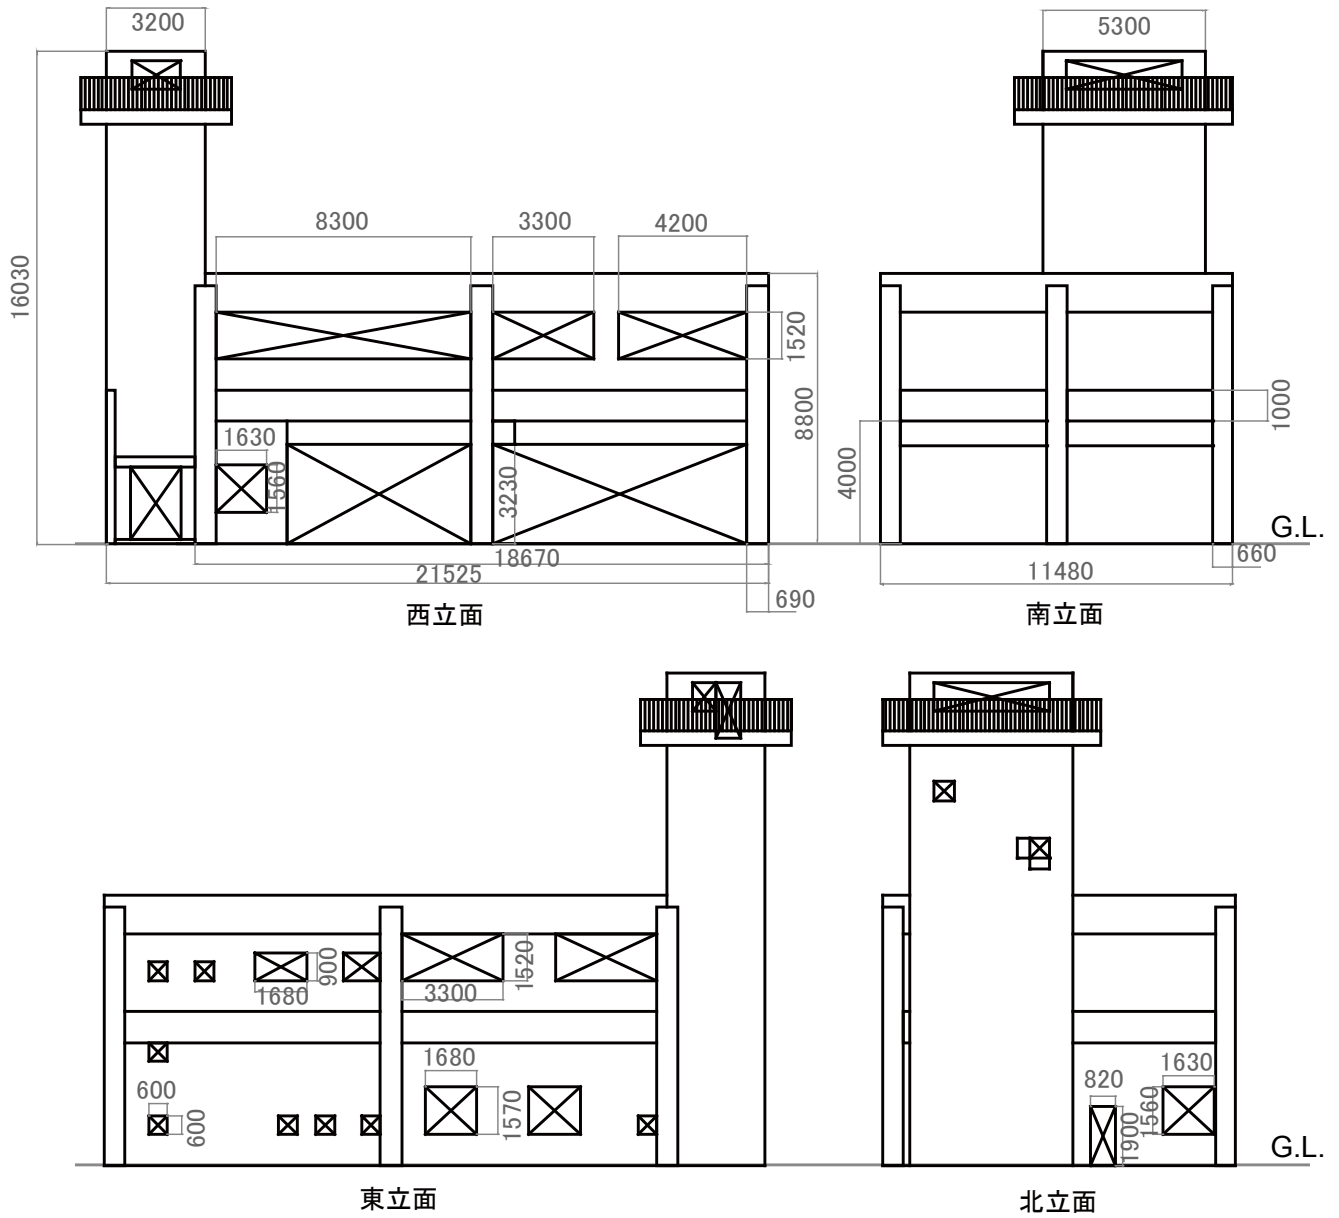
調査対象建物 立面図 (単位: mm)
